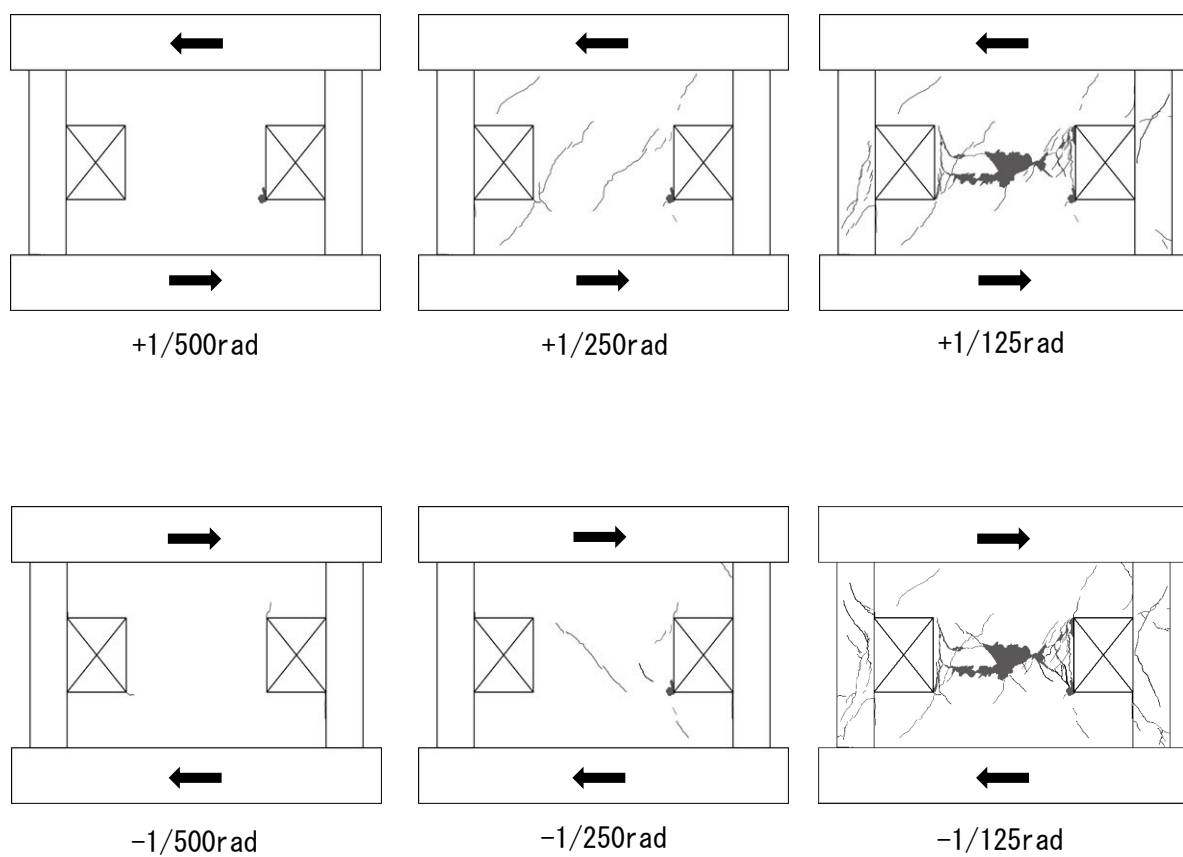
各層間変形角のひび割れ状況図 (F7-DWE-1.5)
